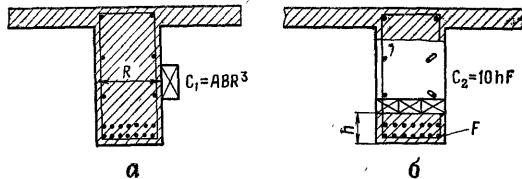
Раздельное (последовательное) подрывание бетона и арматуры:
